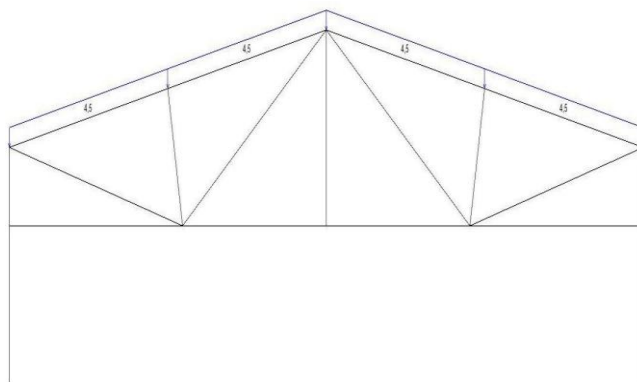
Снігове навантаження на ферму, варіант 1
